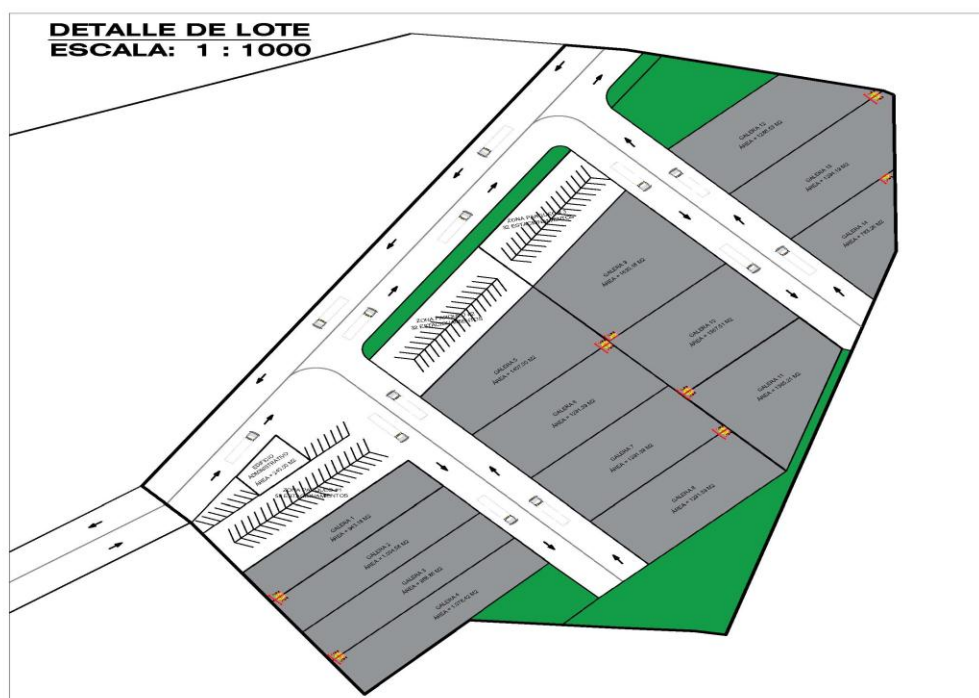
Vista del detalle del proyecto. Fuente: Planos del proyecto.
